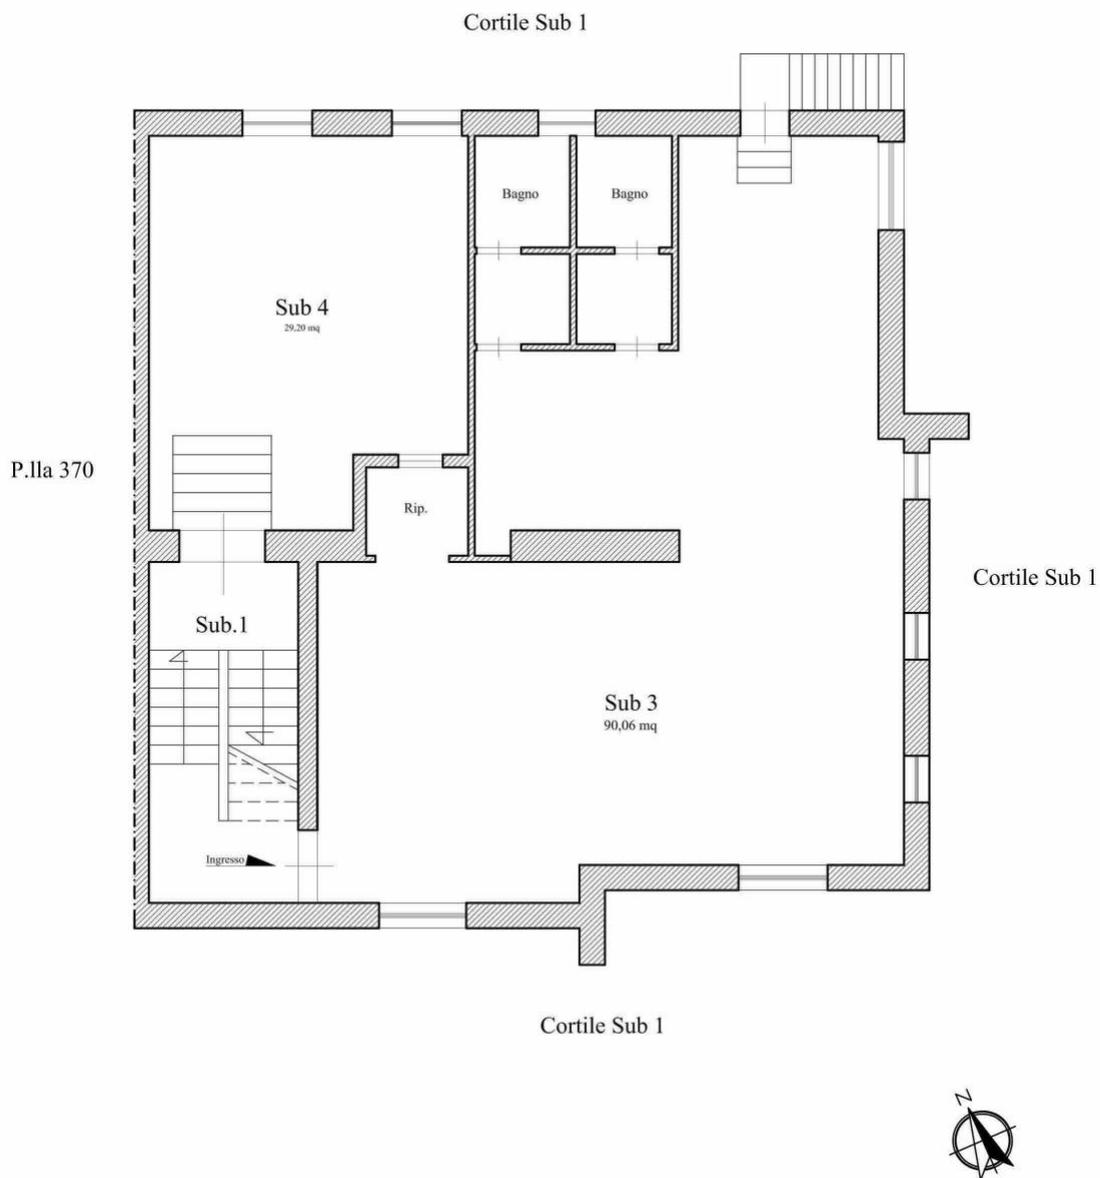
Grafico stato dei luoghi locale deposito – foglio 11 – P.la 369 – Sub. 4 e locale artigianale sub.3
